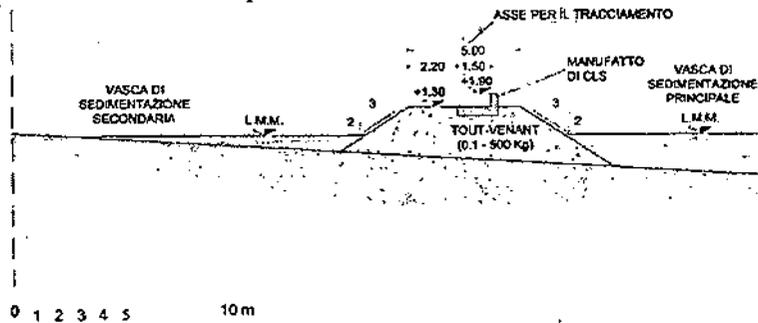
Sezione tipo F-F (argine di delimitazione vasca di sedimentazione secondaria)
